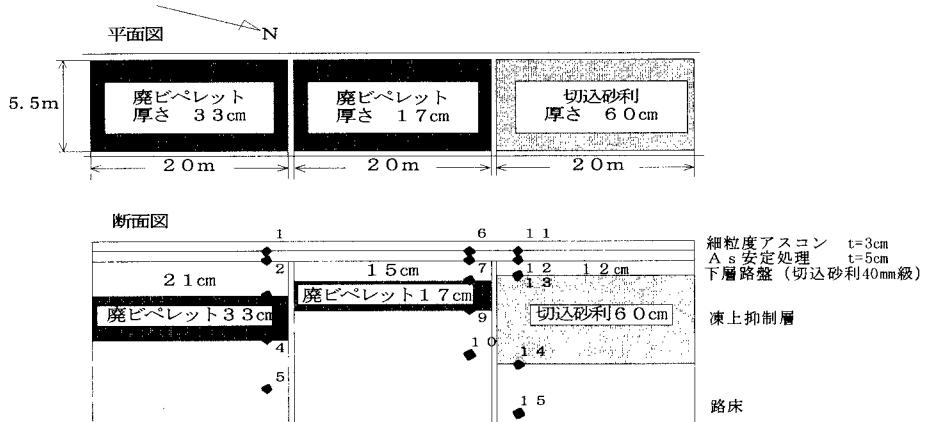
北海道空知郡栗沢町での野外実験場の平面図及び断面図
